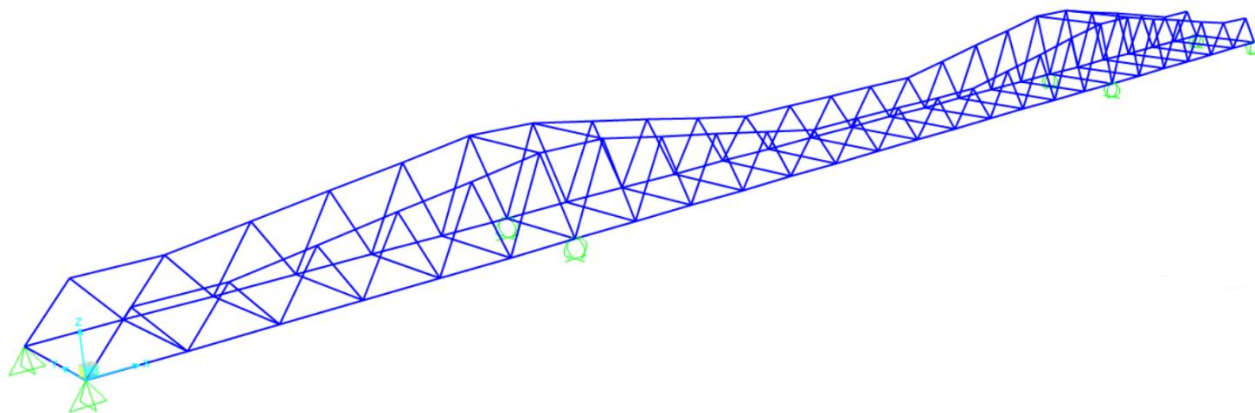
Modelo estructura con carga Peso Propio (Fuente: SAP2000).
